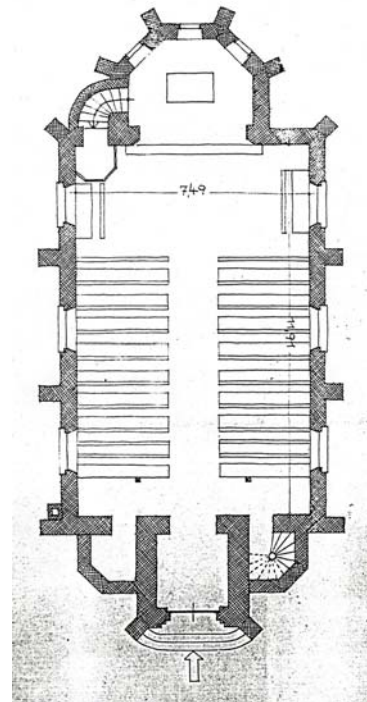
Grundriss Erdgeschoss, Bauaufnahme 1949
